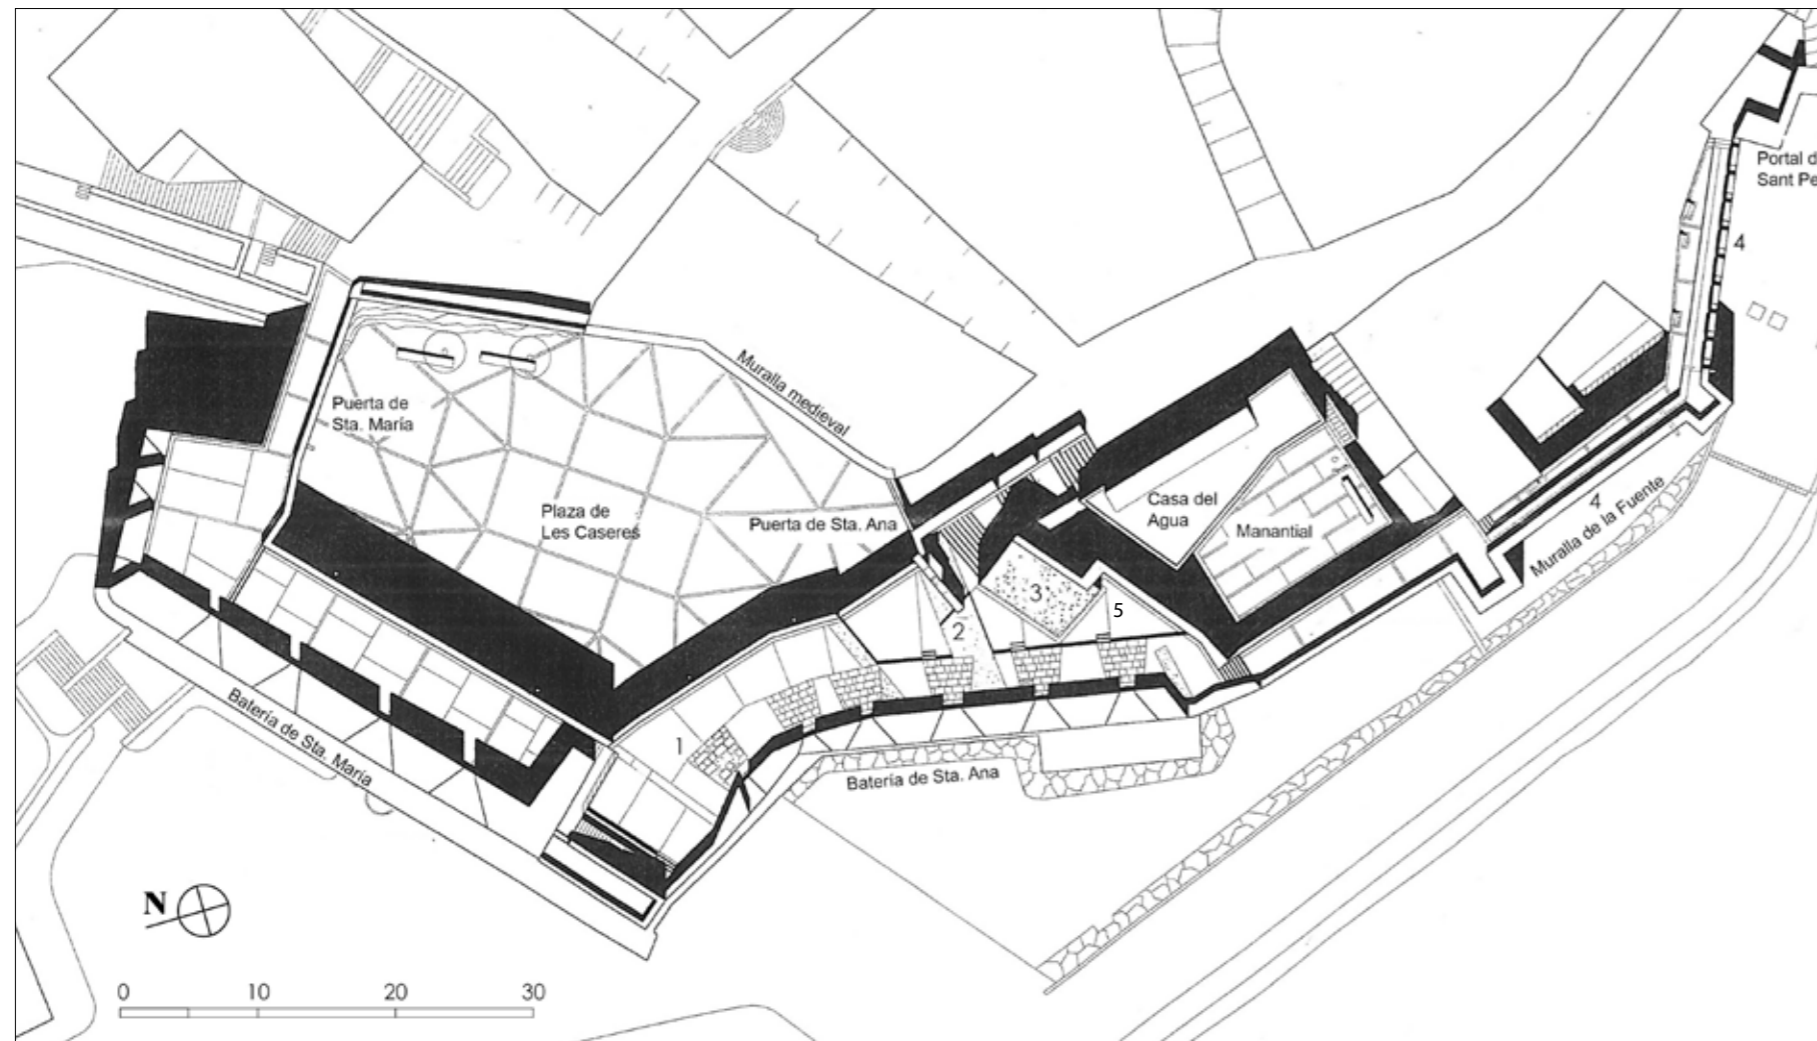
Planta general del Proyecto de restauración de la Plaza de les Caseres y murallas de su entorno señalando los elementos que son los siguientes: 1 Plataforma de artillería original. 2 Muros. 3 Torre medieval. 4 Paso de ronda. 5 Muro del manantial. (MJB 1998).
